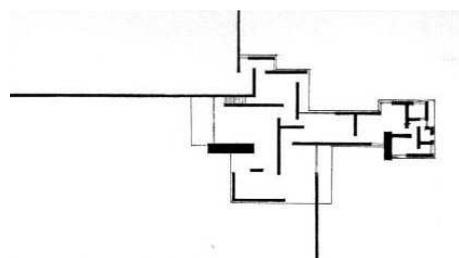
Casa de campo de tijolos, Mies van der Rohe, 1923. Planta baixa.
